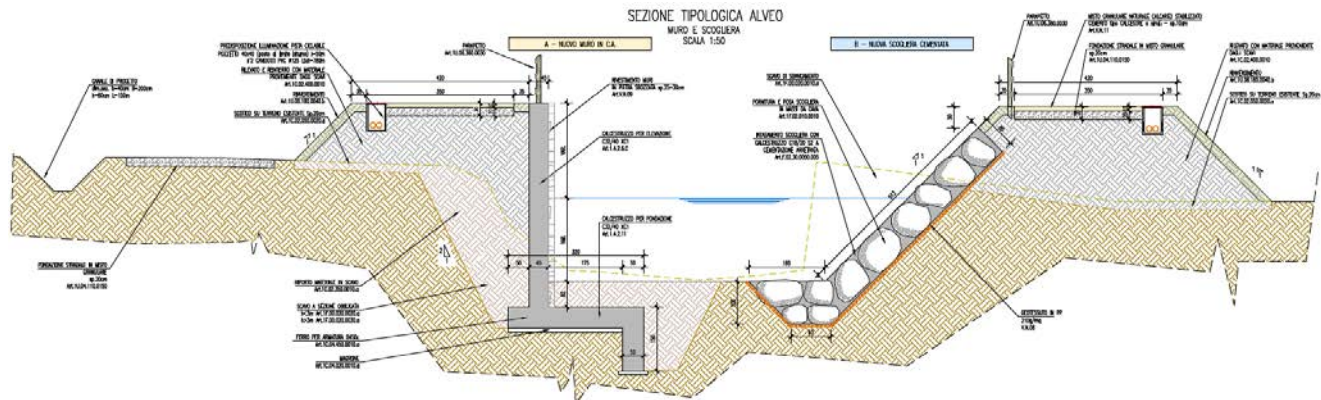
Estratto Tavola 17. Sezioni tipologiche e particolari. Dettaglio dell'intervento A – Nuovo muro in calcestruzzo armato e B – Nuova scogliera cementata.
